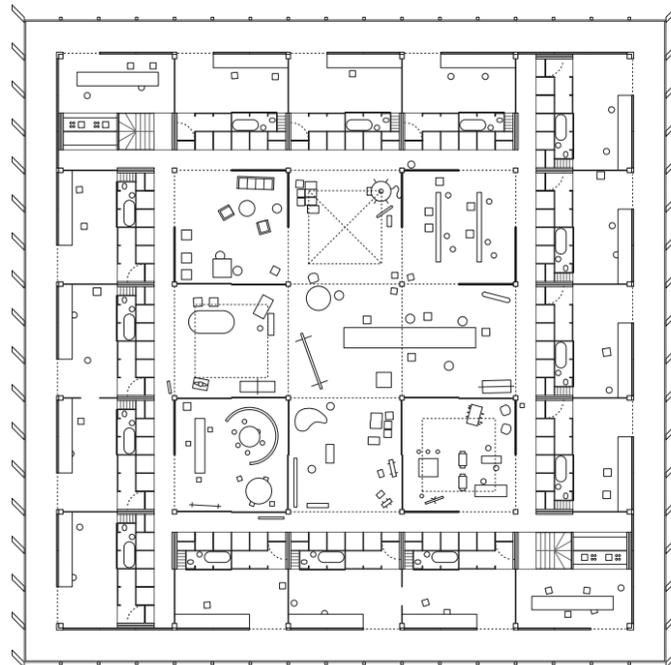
DOGMA, Villa Suburbana, Grundriss
